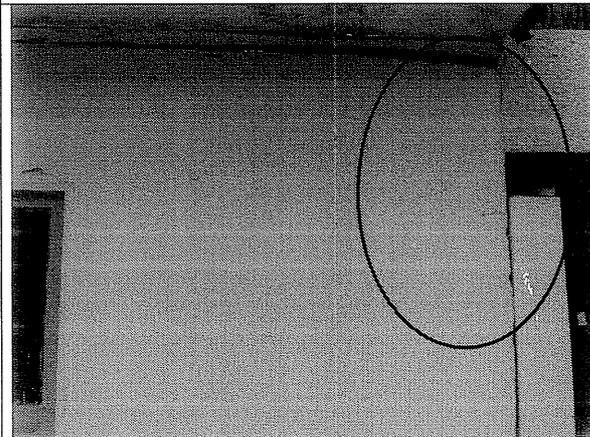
Fisuras y deterioro de acabados en el extremo oriental del muro de fachada.
